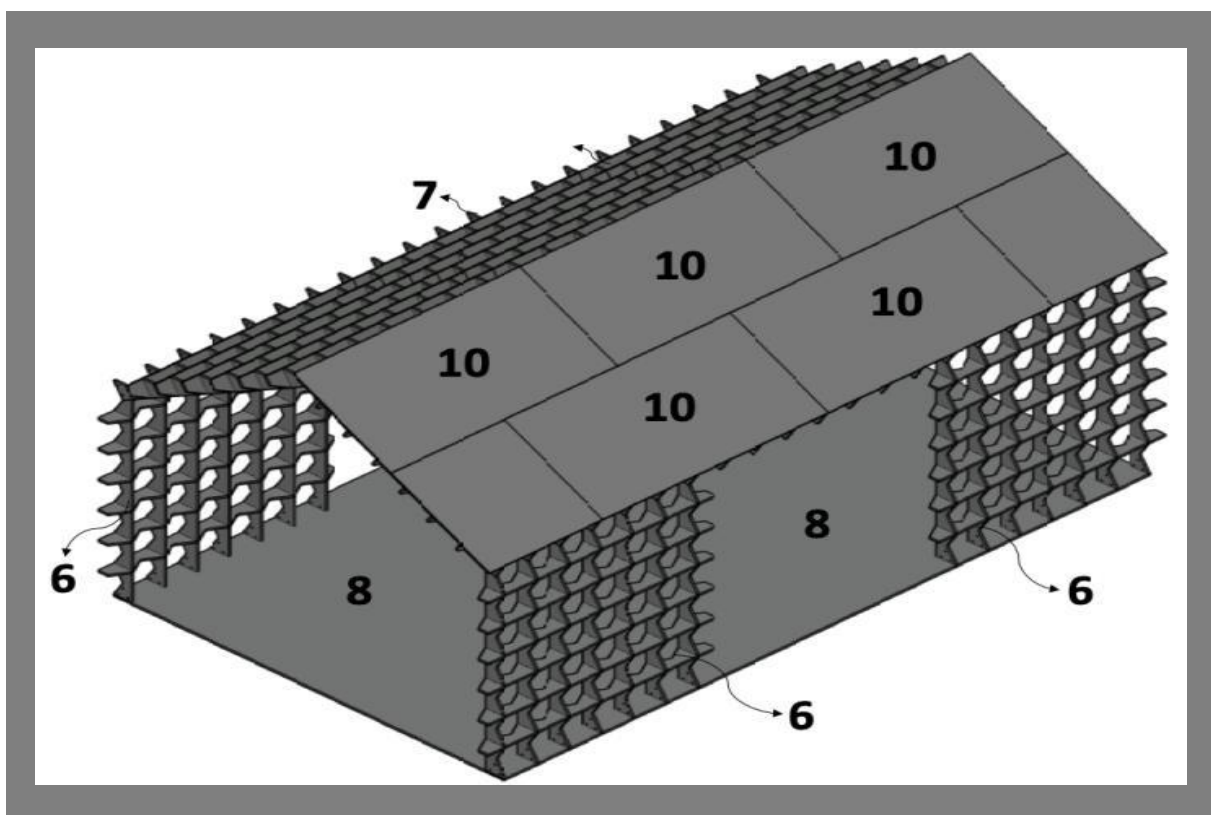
Fase (1) Isométrico de 3 módulos (6), sobre un firme de concreto (8) y piel estructural en muro y cubierta (7) con su recubrimiento (10). Fuente: Elaboración propia.
